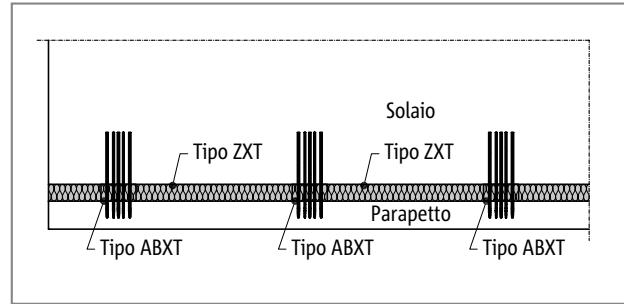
Schöck Isokorb® tipo ABXT - disposizione verticale, pianta del parapetto anteposto
